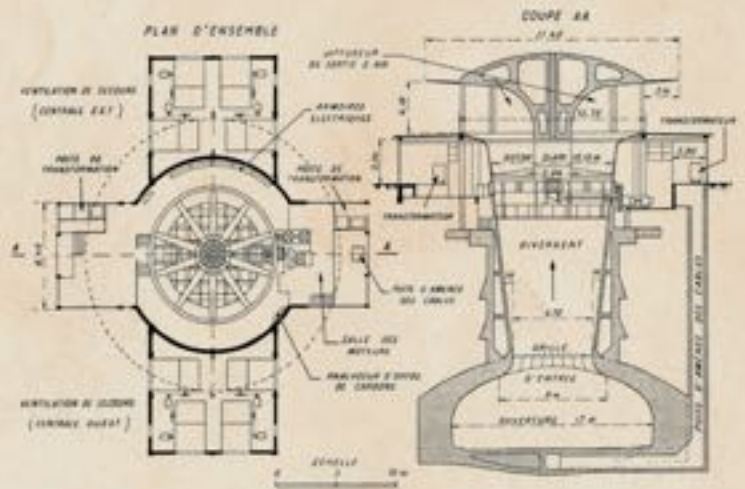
Installation de ventilation. Plan d'ensemble. Coupe AA'.
